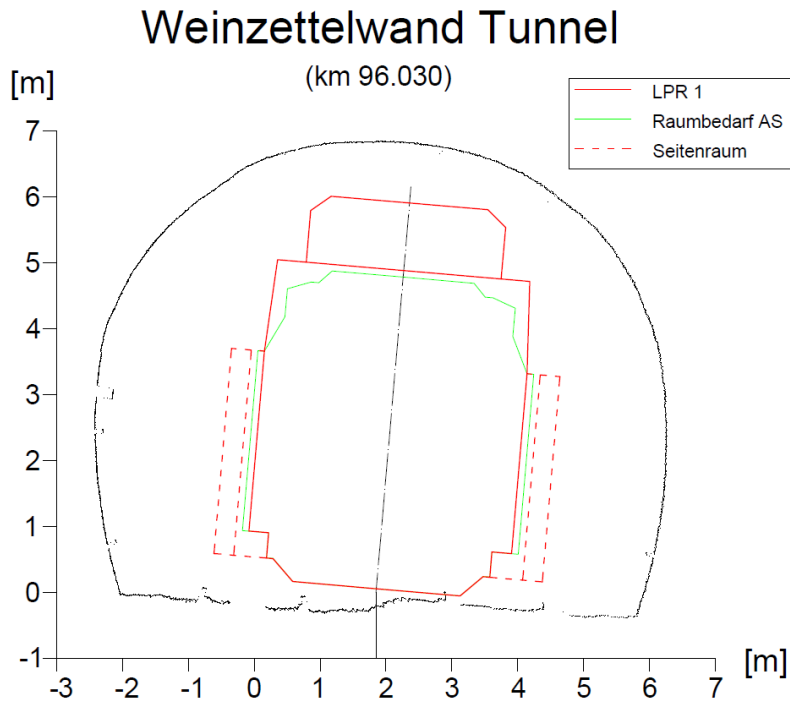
Tunnelprofil Weinzettelwand Tunnel [87]
